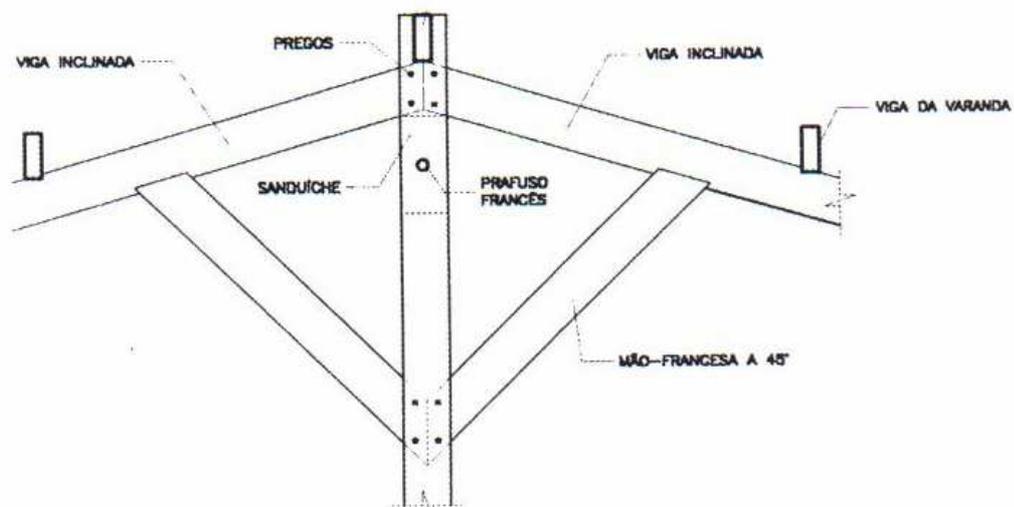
Precasa (2000) - Detalhe do vigaamento.
